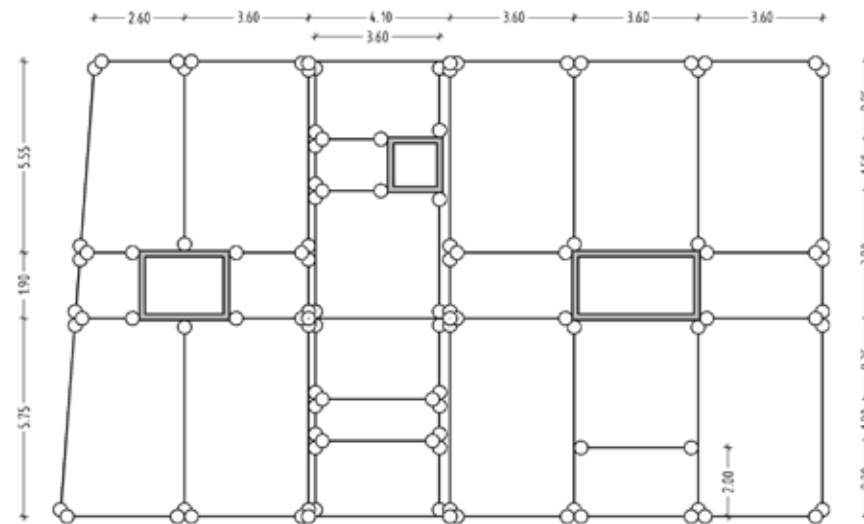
Grundriss Kern I [m]
